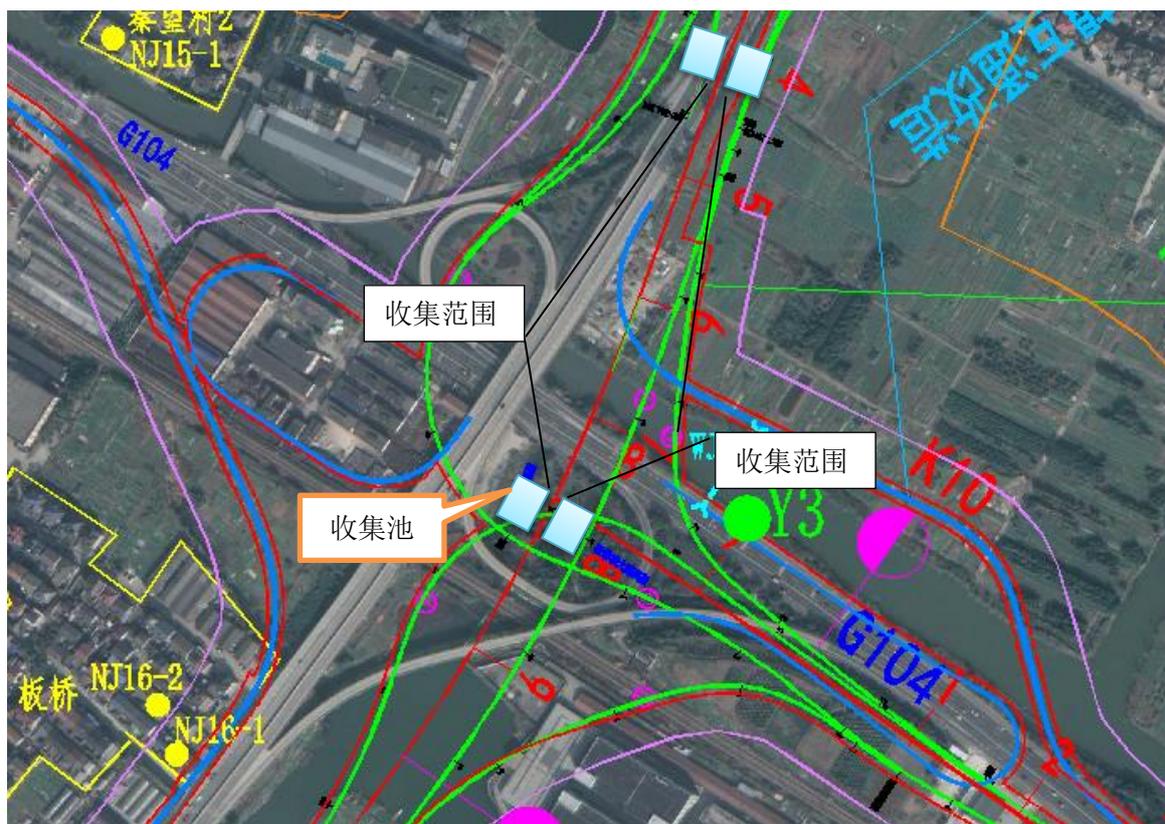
项目新秦望互通主线桥 1 跨越浙东运河收集系统平面布置图
